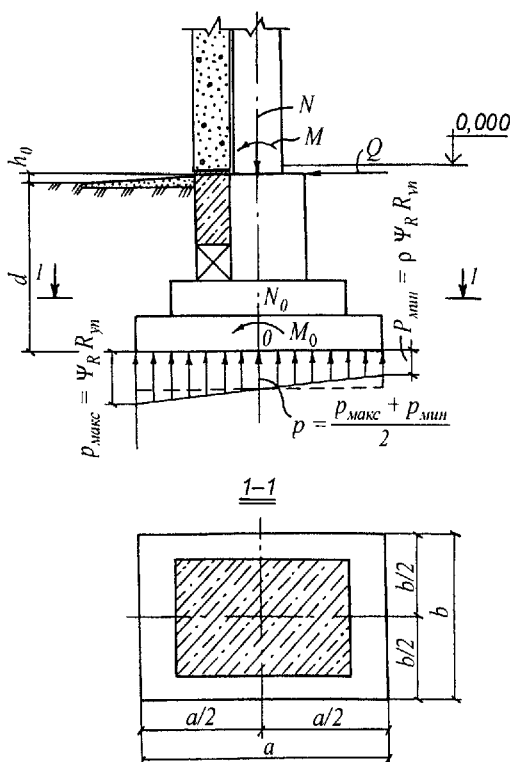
Расчетная схема внецентренно нагруженного фундамента реконструируемого здания
